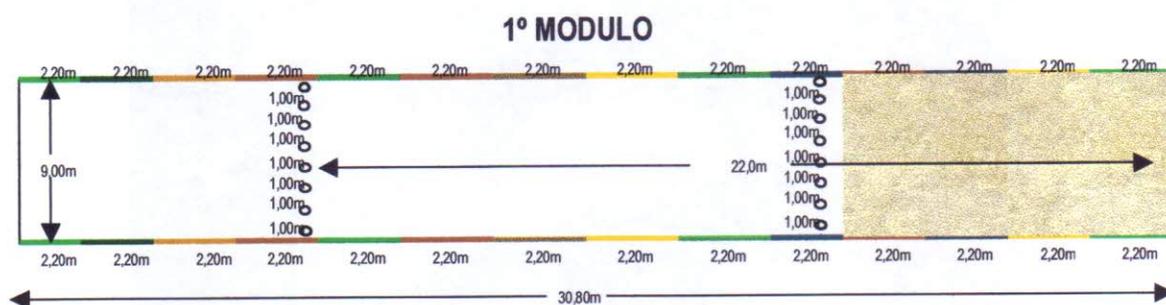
Escavação parcializada, sendo executada em cada 2 lamelas por módulo. A medida, que se avança à escavação, após 8 lamelas, existe a necessidade da instalação de um outro jogo de ponteiros, tendo em vista surgência de água.
